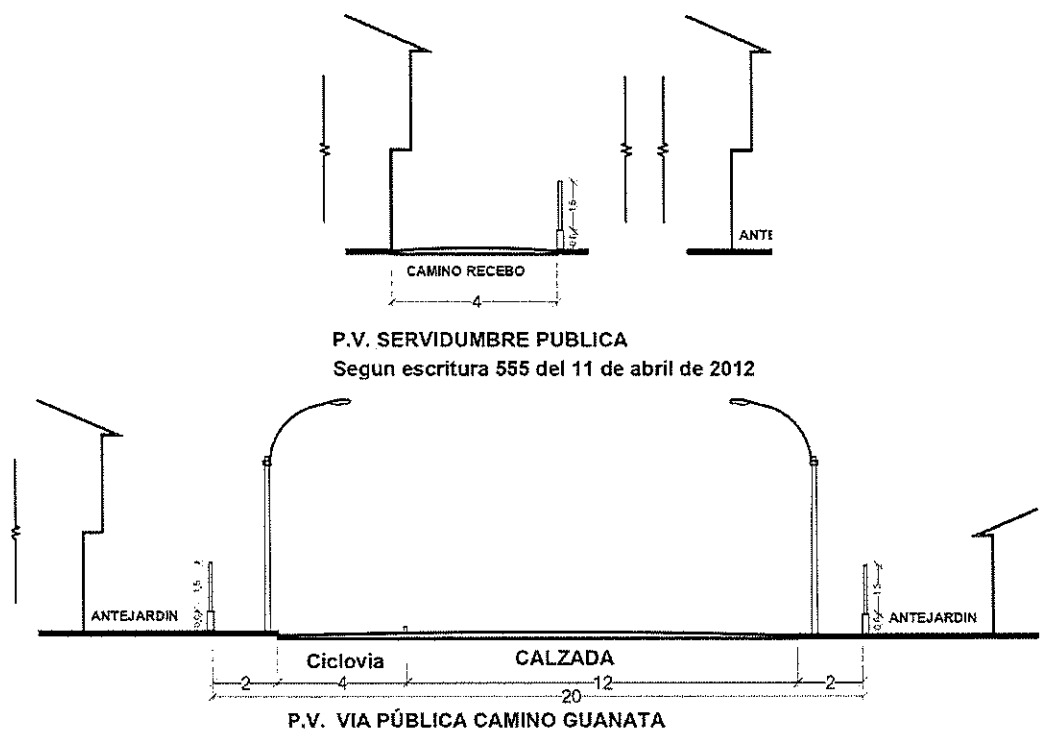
Perfil vial propuesto para vías PÚBLICAS
